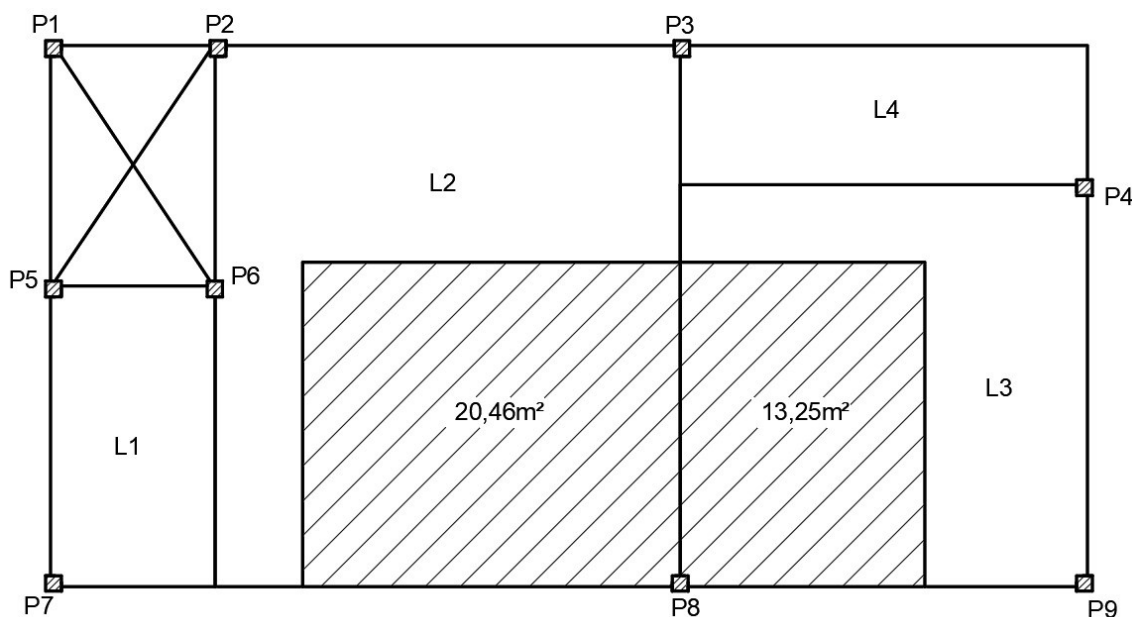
Área de influência do pilar P8 – teto do 1º e do 2º pavimento
